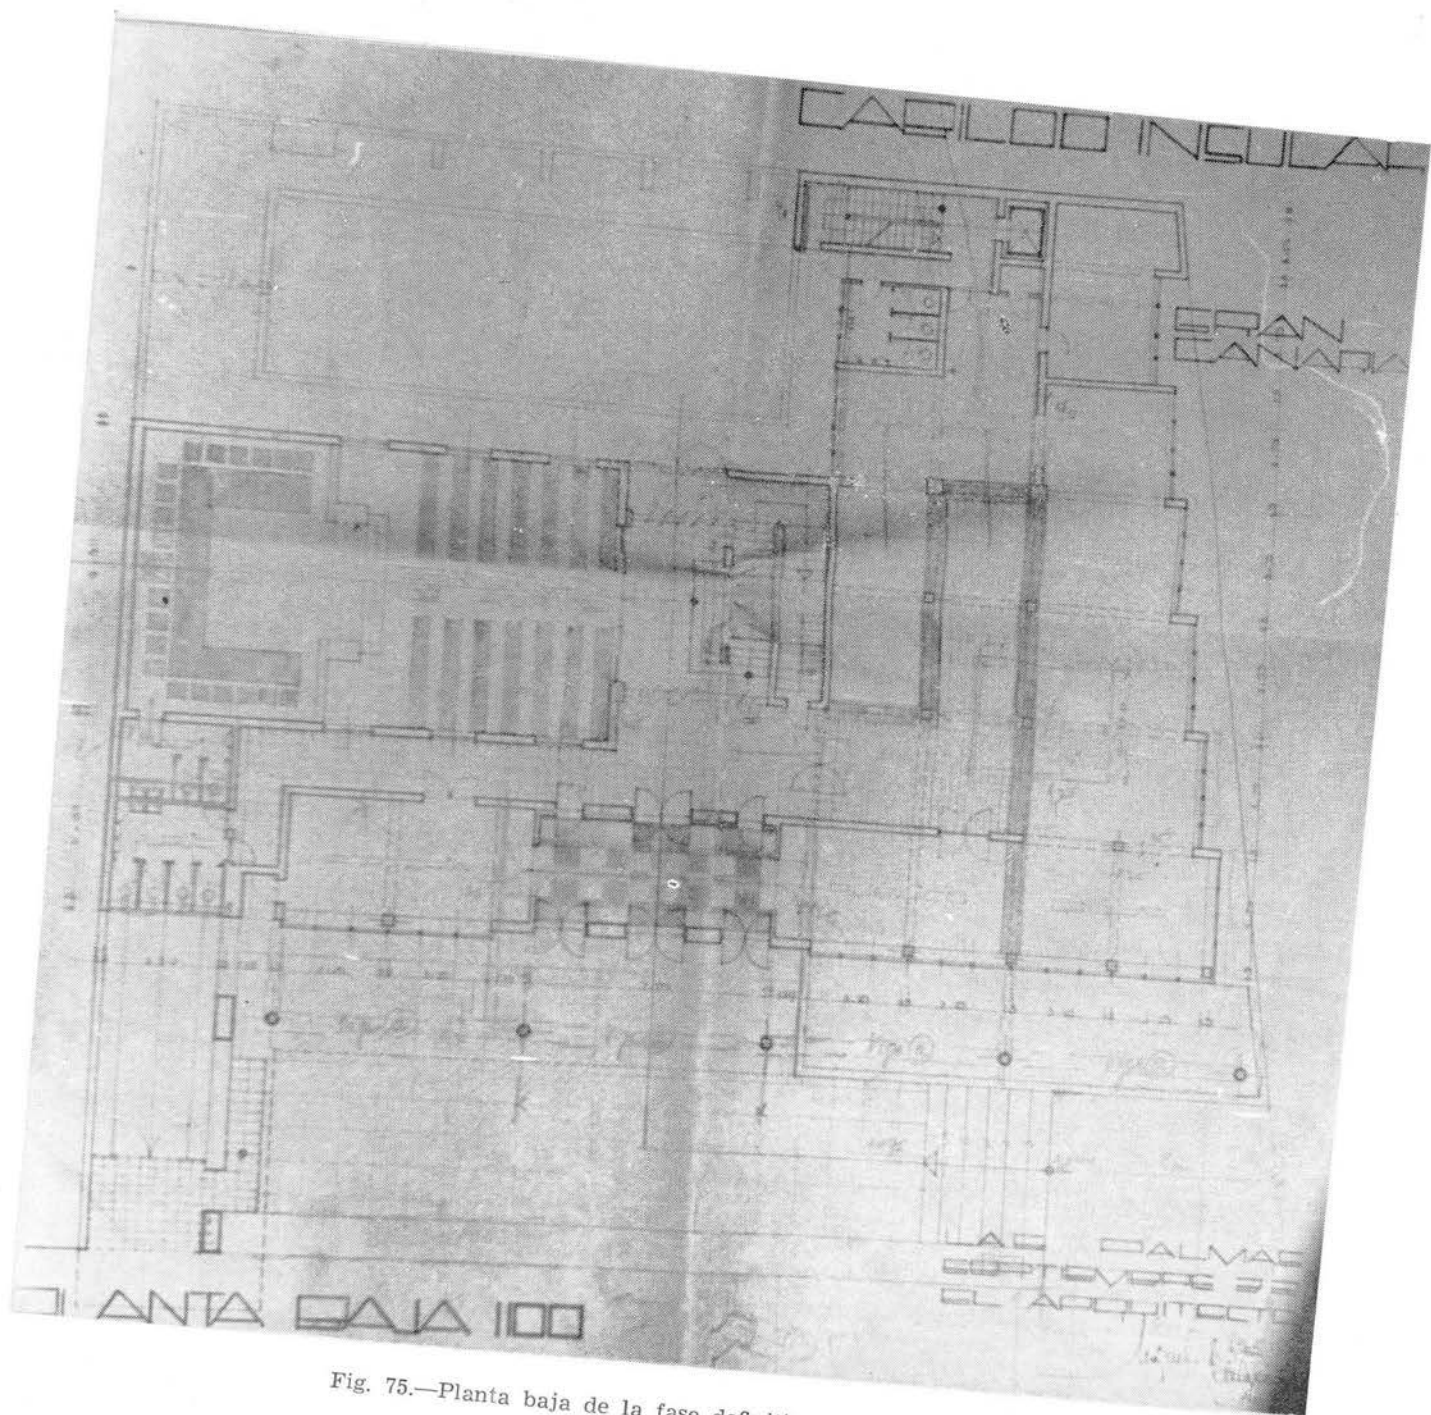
Planta baja de la fase definitiva del proyecto.
